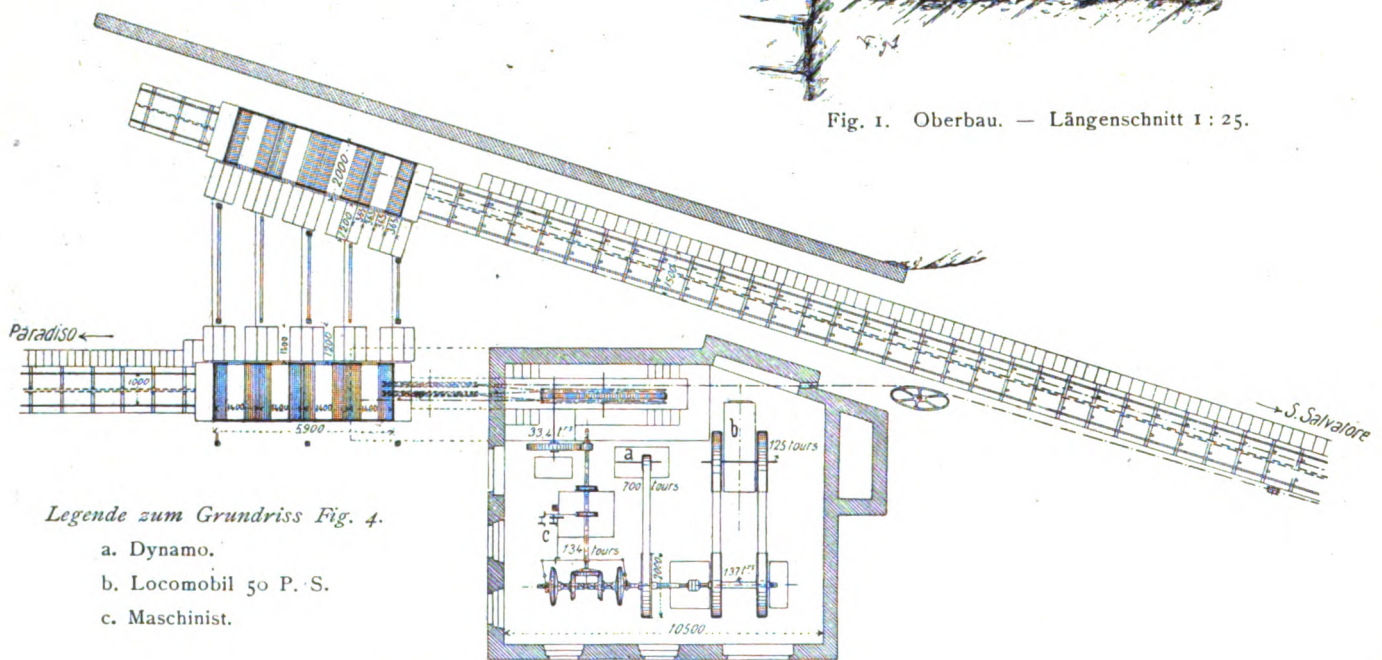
Umsteigstation in der Mitte. — Grundriss 1 : 250.
